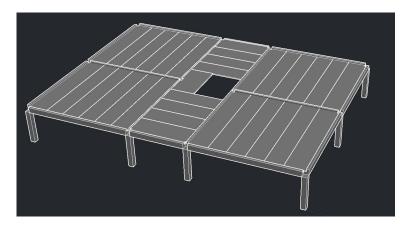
Losas utilizadas en el sector caja escala. Fuente: Elaboración propia
